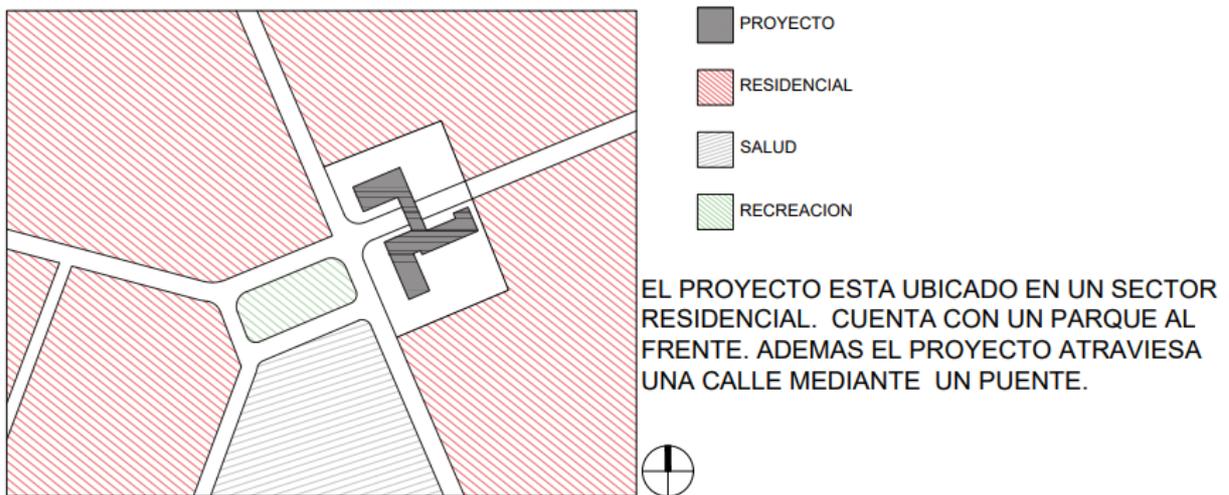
Emplazamiento de la Bauhaus. Elaboración propia.
